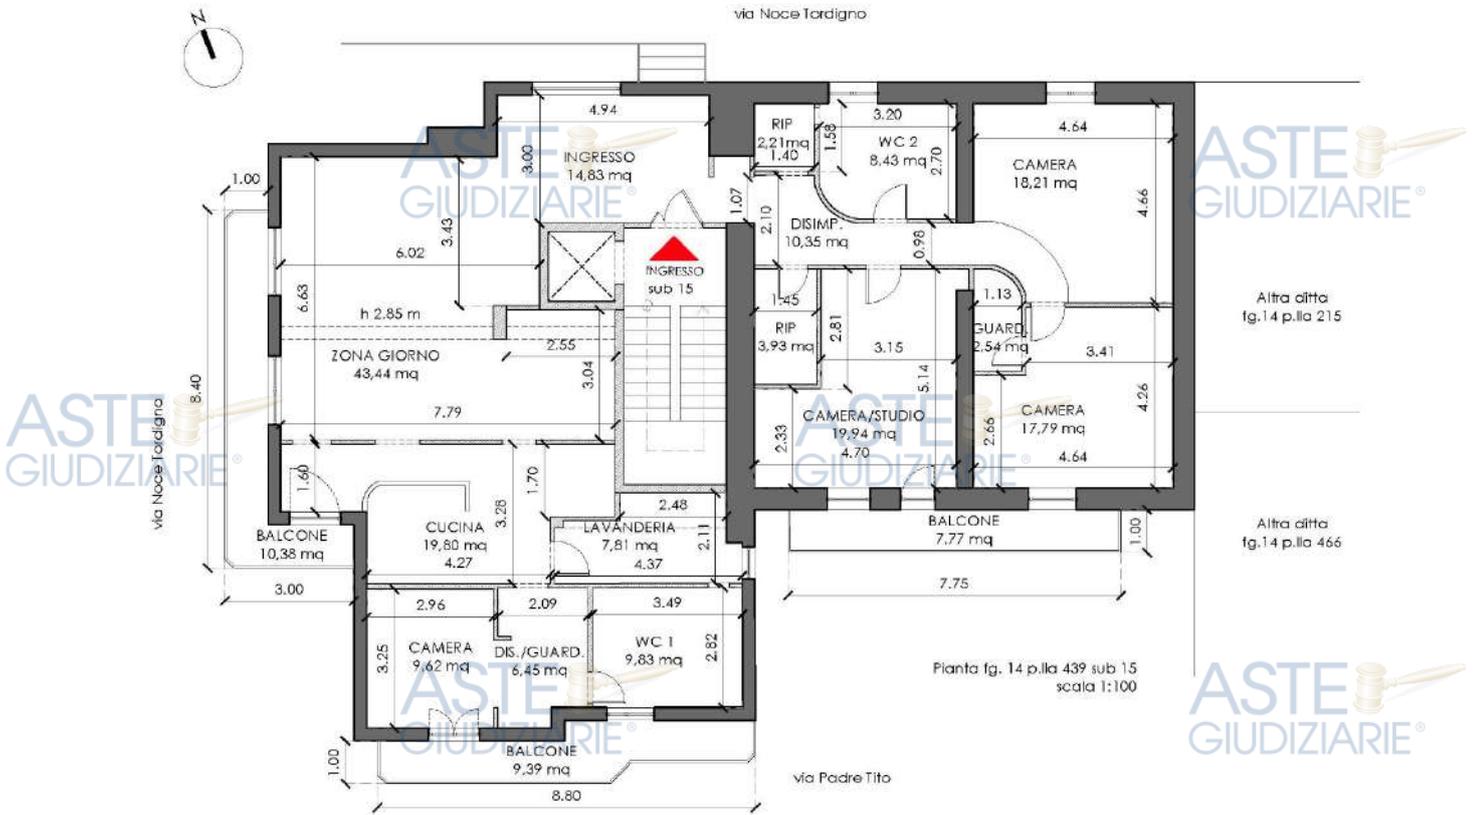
Rilievo Abitazione Lotto Due Stato di fatto \_ pianta piano terzo (Allegato 6E)
